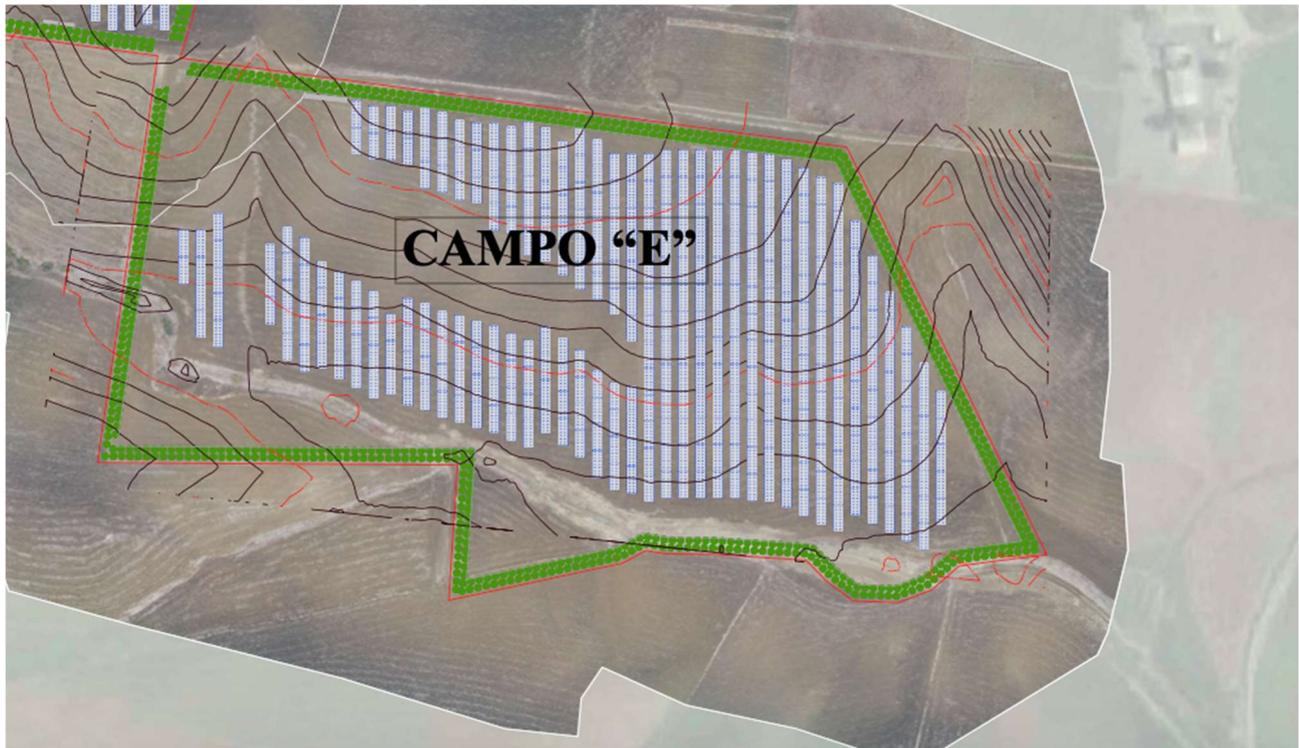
Particolare Layout di impianto area E su stralcio rilievo
